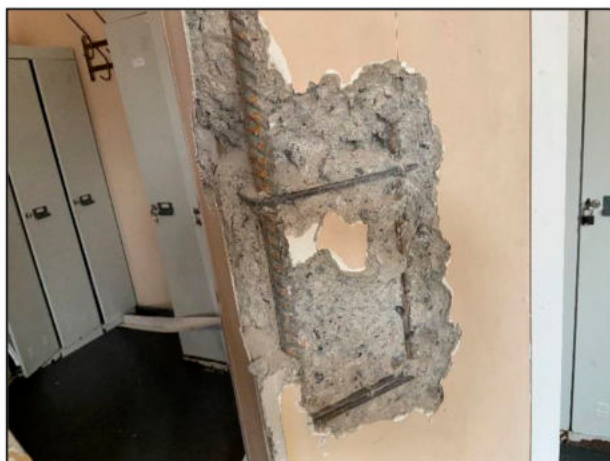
Общий вид вскрытия средней колонны каркаса в уровне 1-го этажа здания в осях «1-6/А-И»
